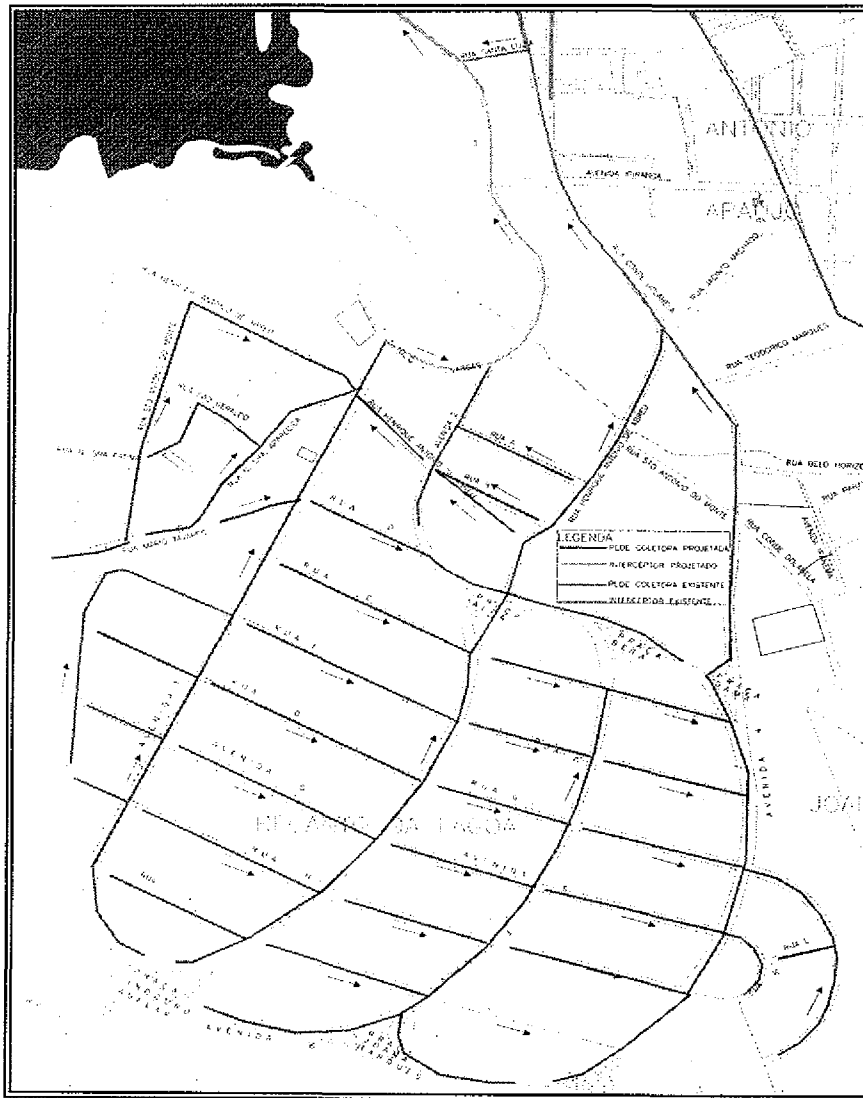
Sistema Projetado – Bairro Recanto da Lagoa
